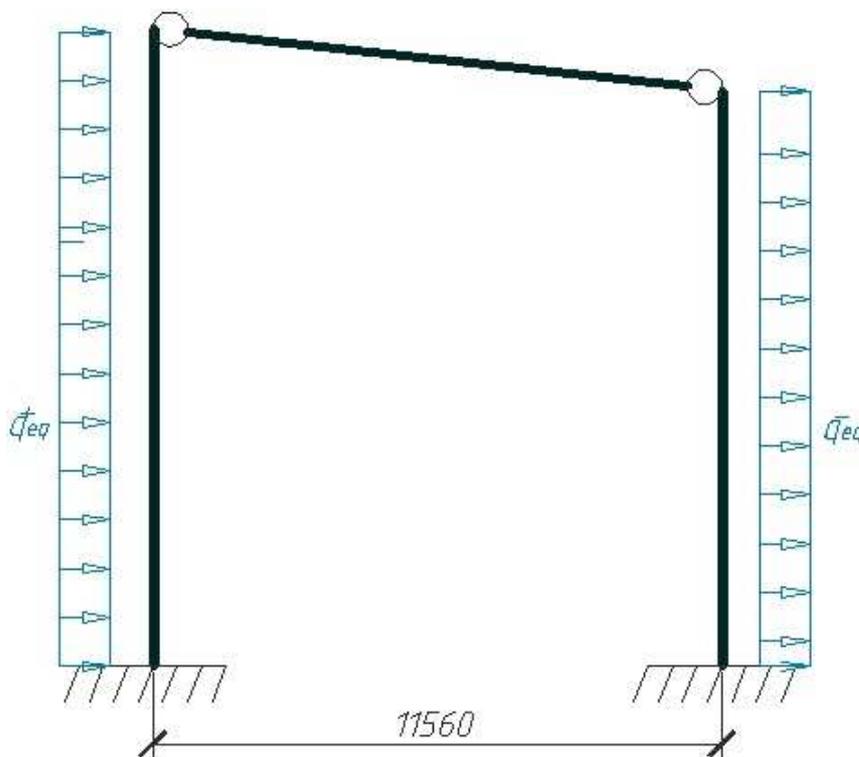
Ветровая нагрузка на перекрытие
